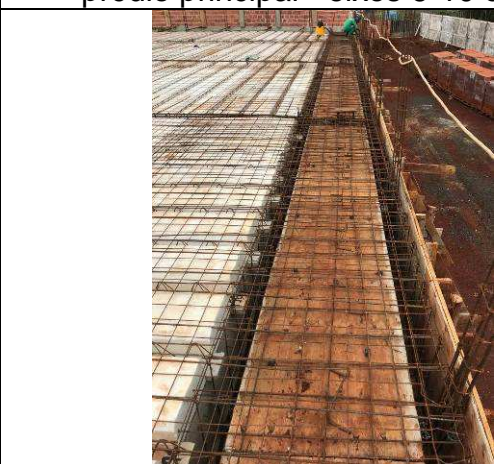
C: Lajes e vigas de cobertura do prédio principal - eixos 6-10 e G-I.
